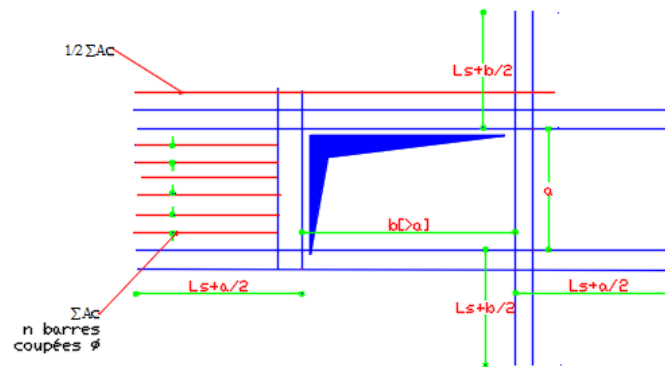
FERRAILAGE D'UNE OUVERTURE DANS UNE DALLE PLEINE
